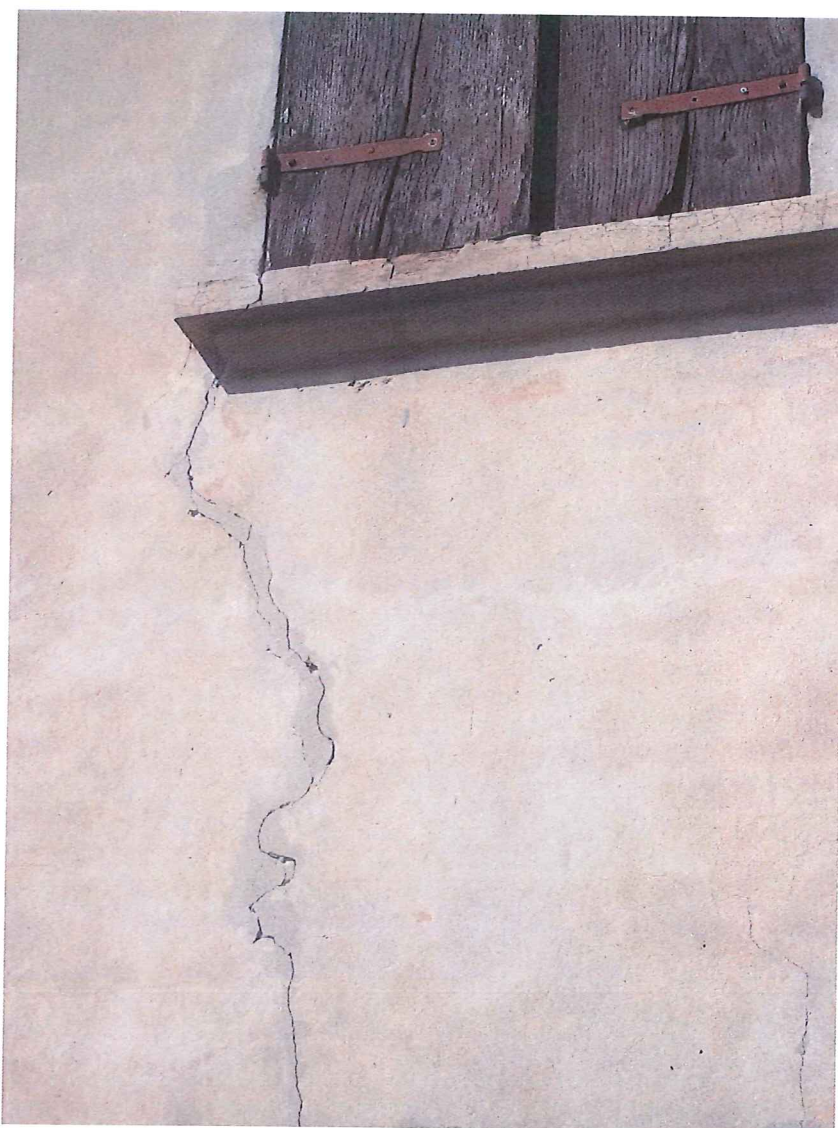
= Prospetto principale – Dettaglio di una lesione esistente su un bancale
